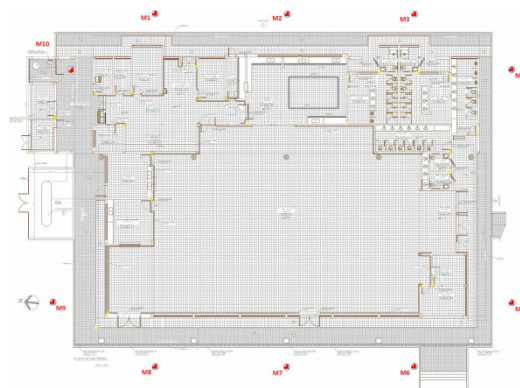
Planta baixa da Edificação e os 10 pontos de medição ao logo da face externa da Edificação
